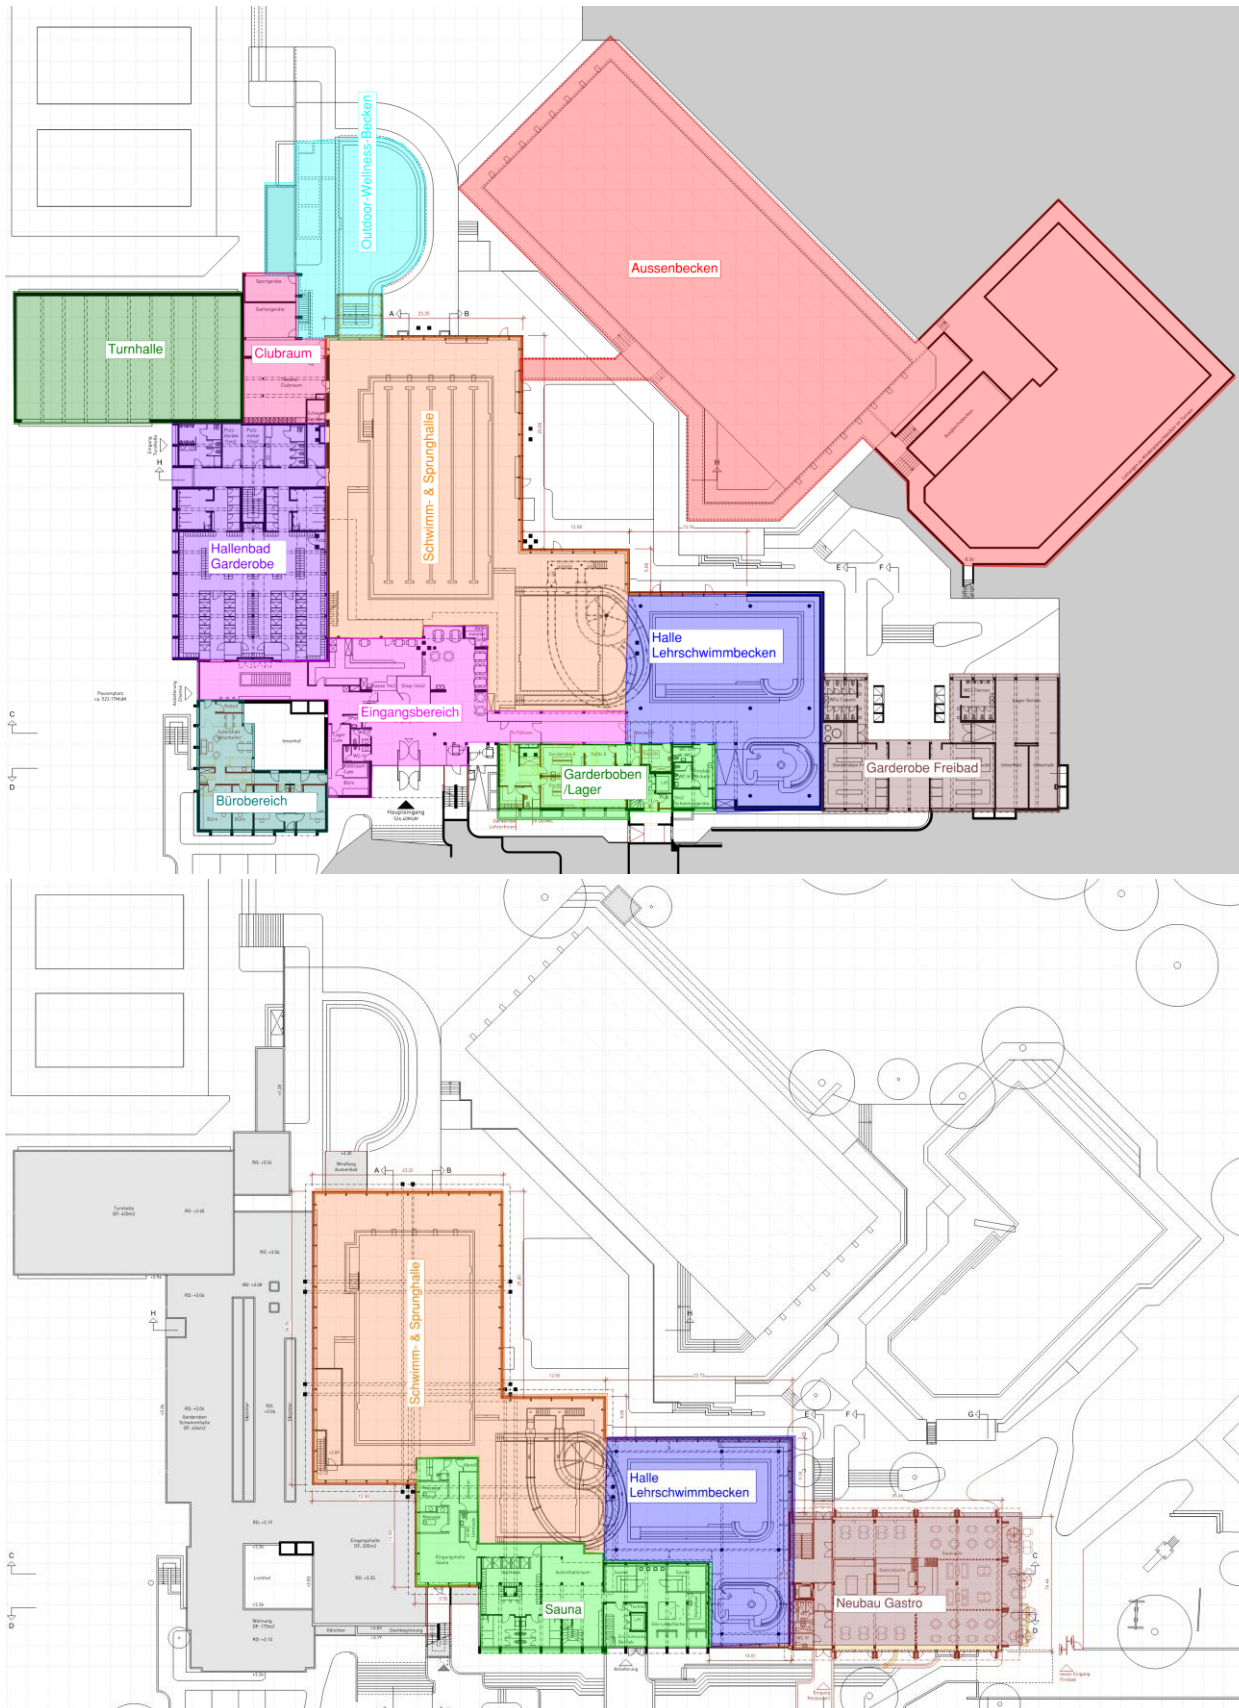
Grundriss Erdgeschoss (oben) und Grundriss Obergeschoss (unten) (Verkleinerungen).
